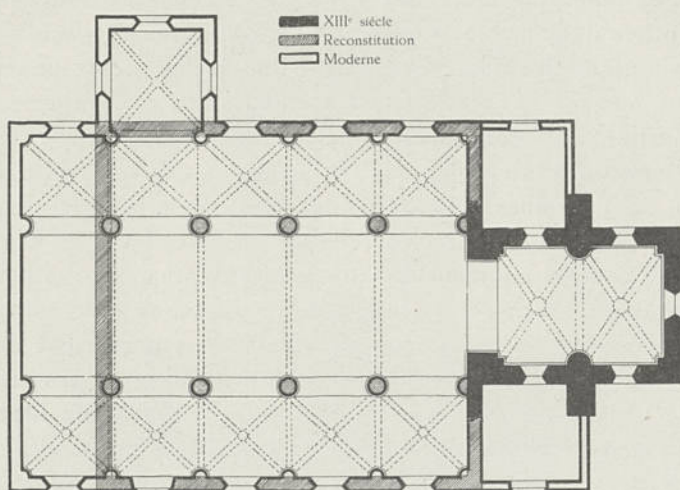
Chaumont, Eglise Saint-Bavon, plan terrier
